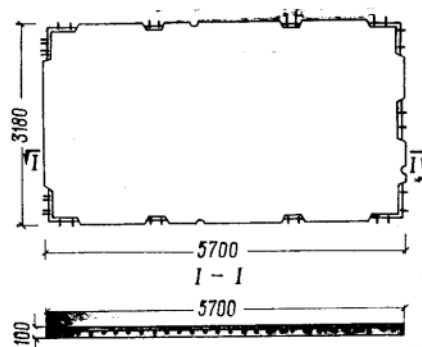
Конструкция панели перекрытия из перлитобетона.
